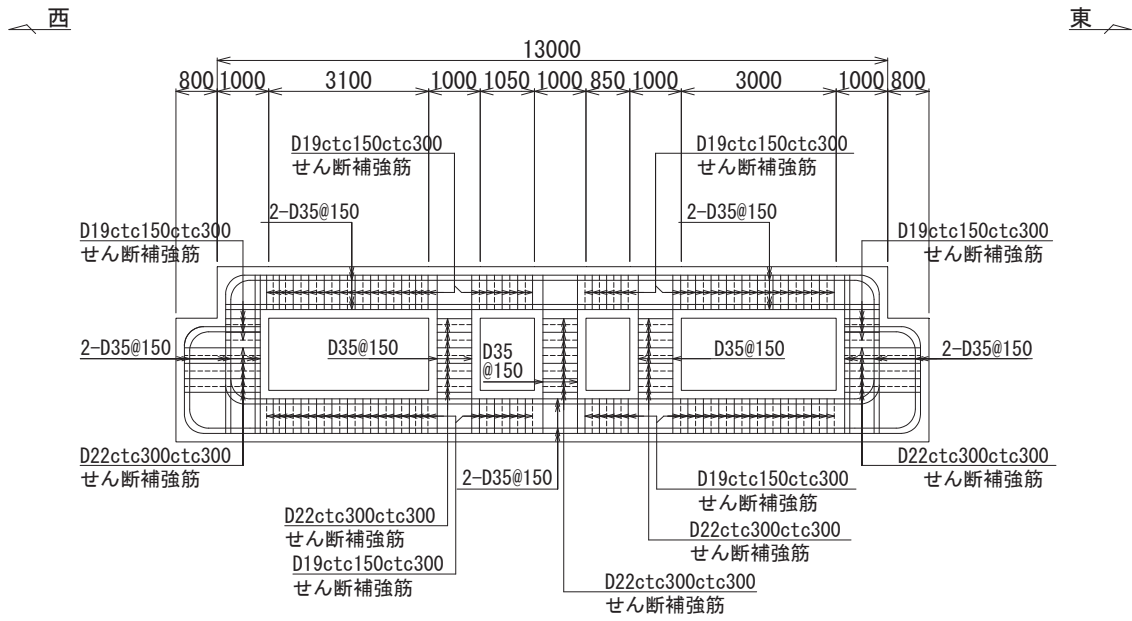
第 3 号機補機冷却海水系放水ピット概略配筋図 (平面図)
